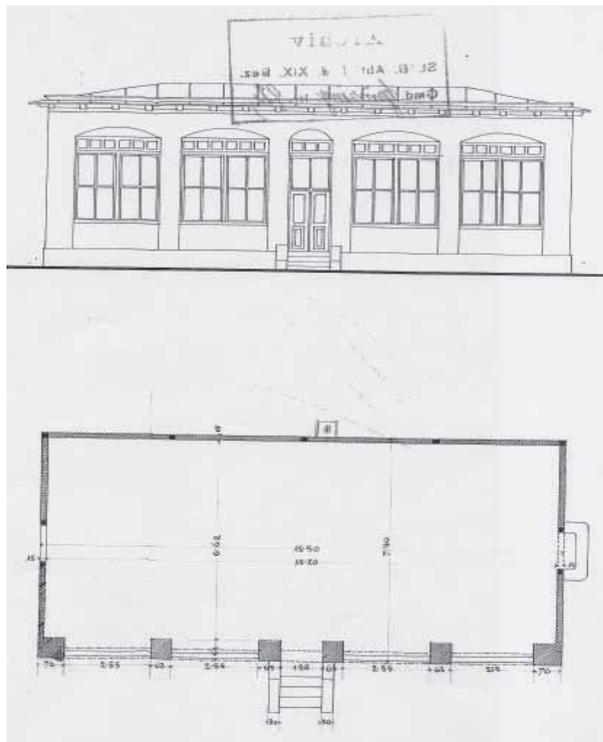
Plan Wiederaufbau Salon Krapfenwaldl
